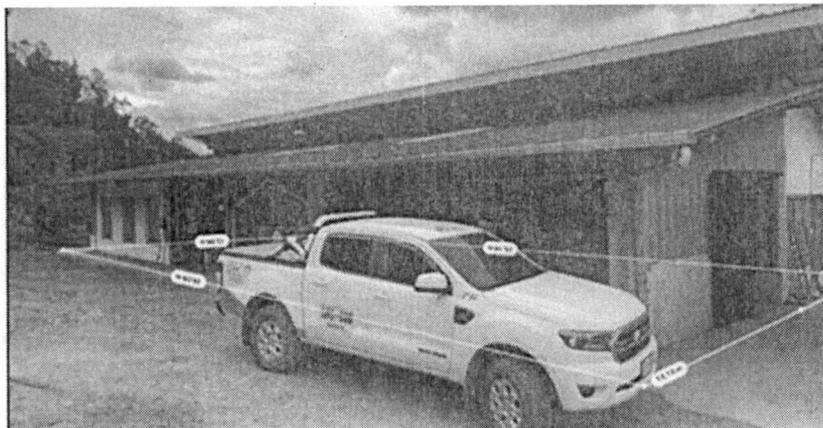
Dimensiones del área adecuada y la infraestructura construida - Visita técnica 17 de julio de 2024.
